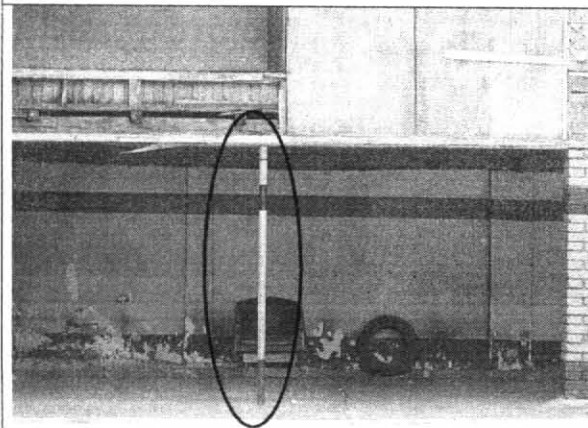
Puntal metálico que apoya el entrepiso en madera.
